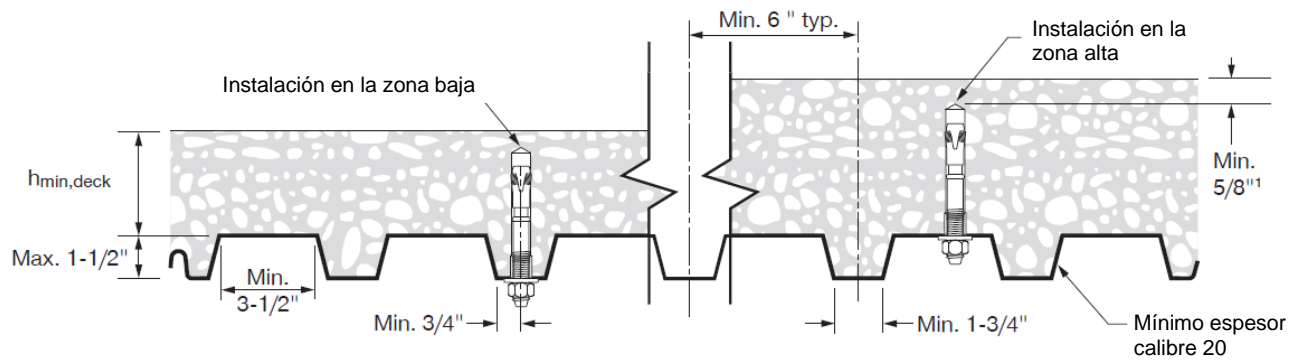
Instalación de Hilti KB-TZ2 sobrecabeza en concreto sobre cubierta metálica - Plataforma tipo B
